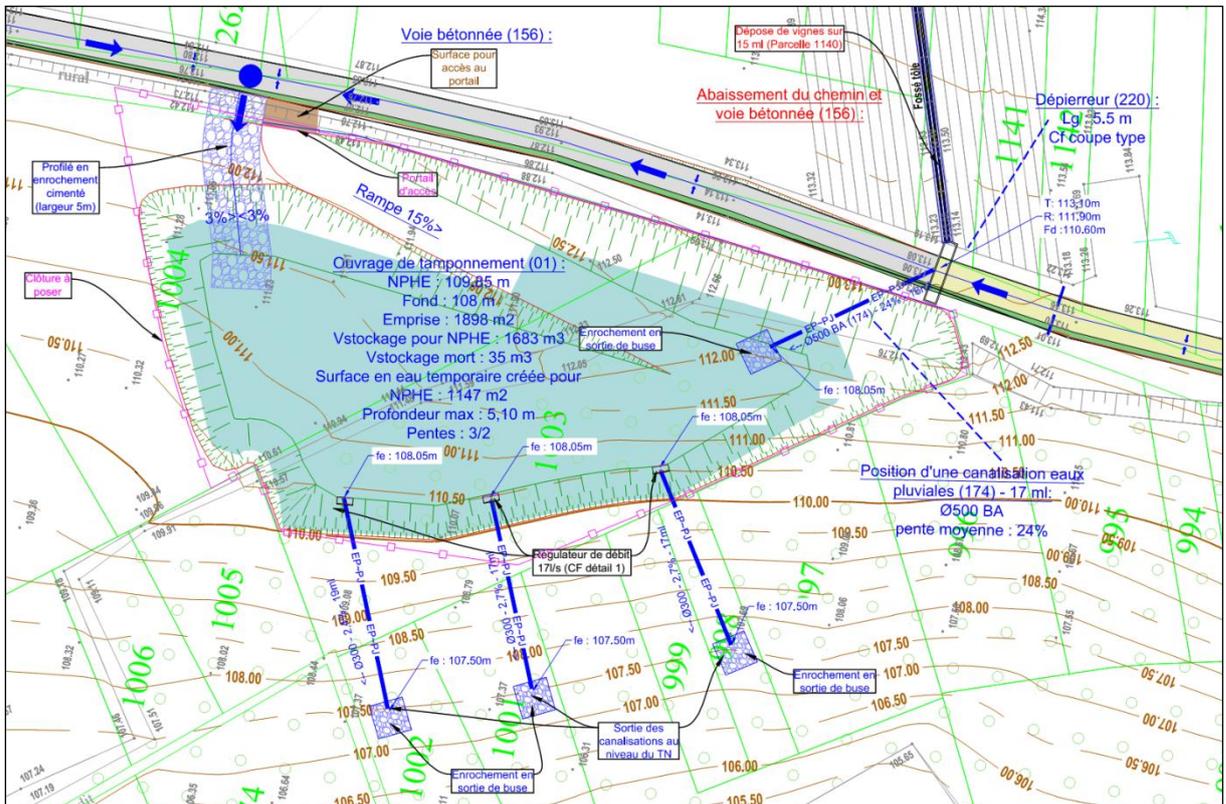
Extrait du plan de masse - Ouvrage de tamponnement n°001
